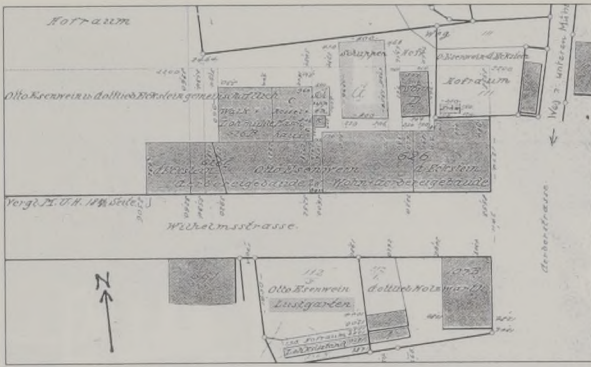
Lageplan von 1887 mit den eingetretenen Grundstücks- und Gebäude-Veränderungen gegenüber dem Plan von 1875.
